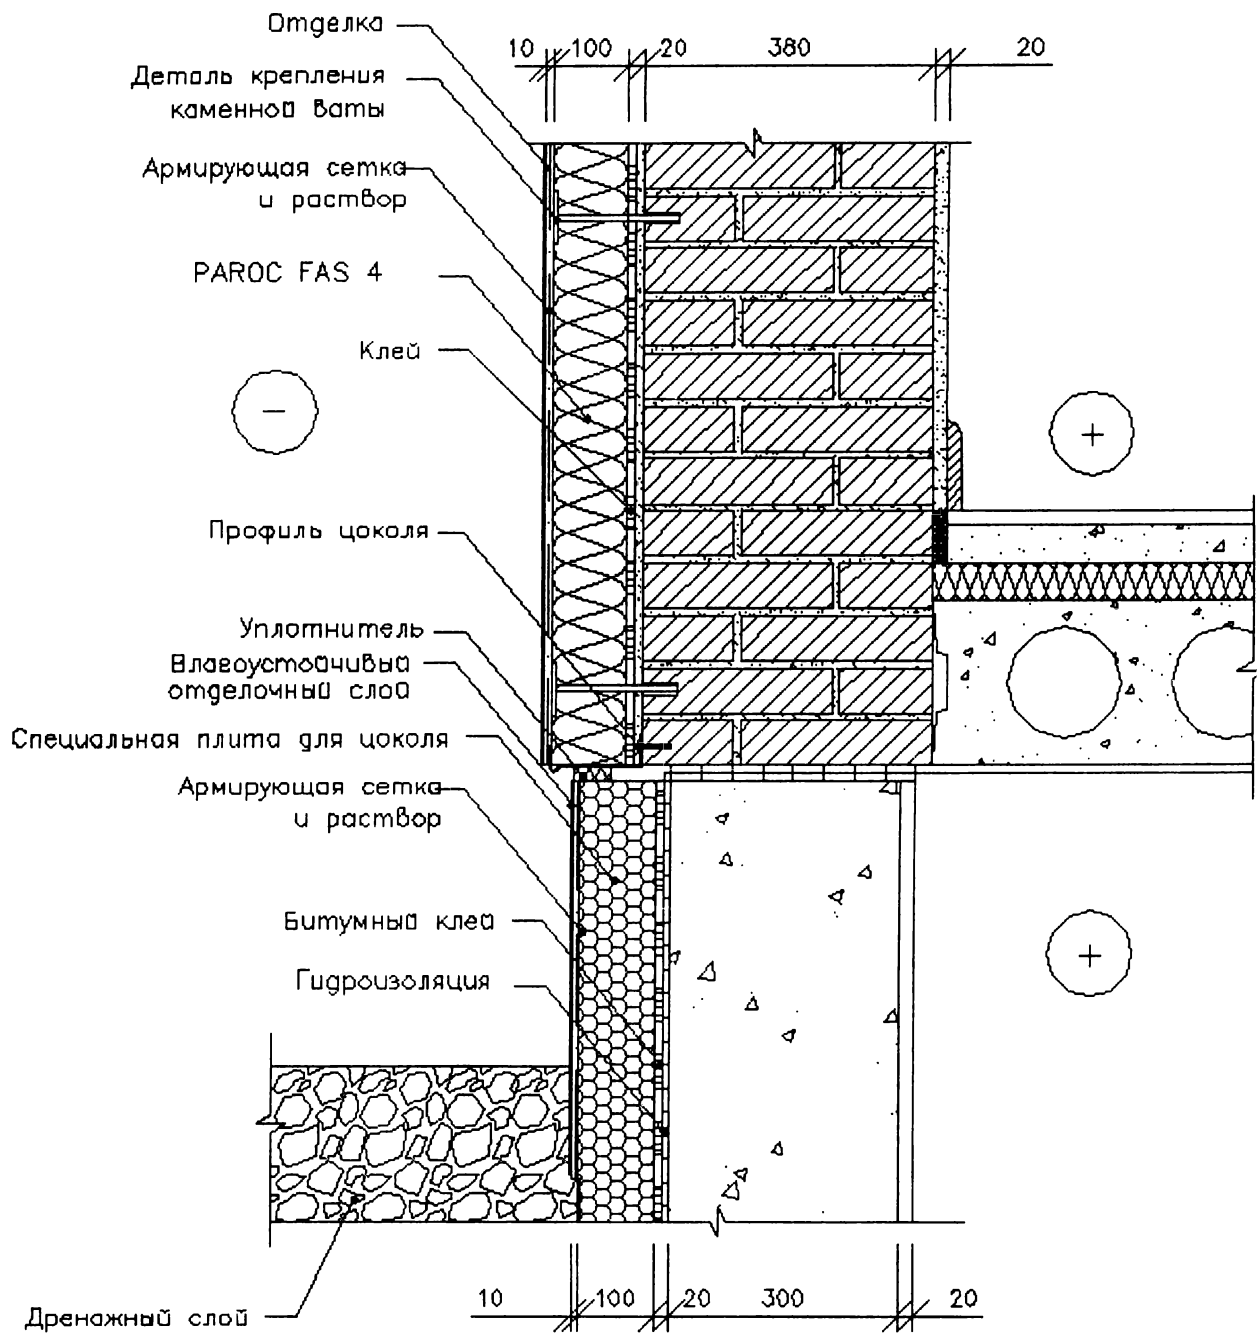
11 – Утепление стены кирпичной кладки и цоколя фундамента, применяя для системы плиту PAROC FAS 4
